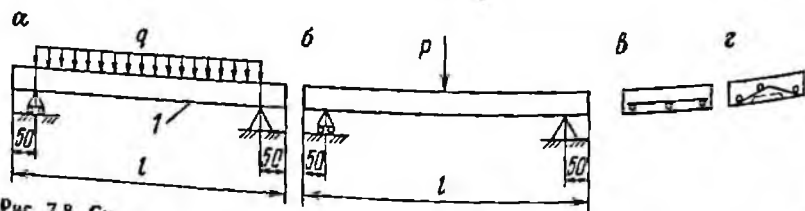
Схема испытания железобетонных плит-затяжек:
